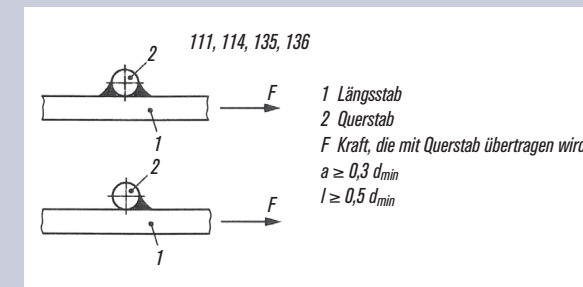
Tragende geschweißte Verbindungen an Betonstählen nach DIN EN ISO 17660-1, Ausgabe Dezember 2006, [9]
